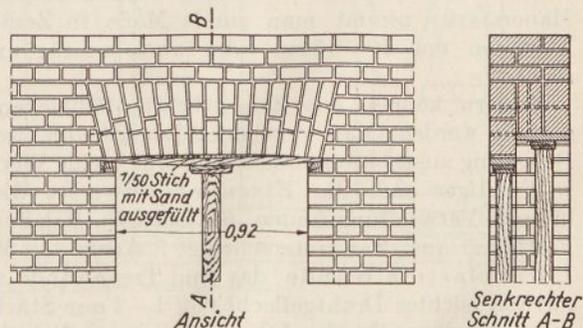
Scheinrechter Sturz für eine Fensteröffnung.
